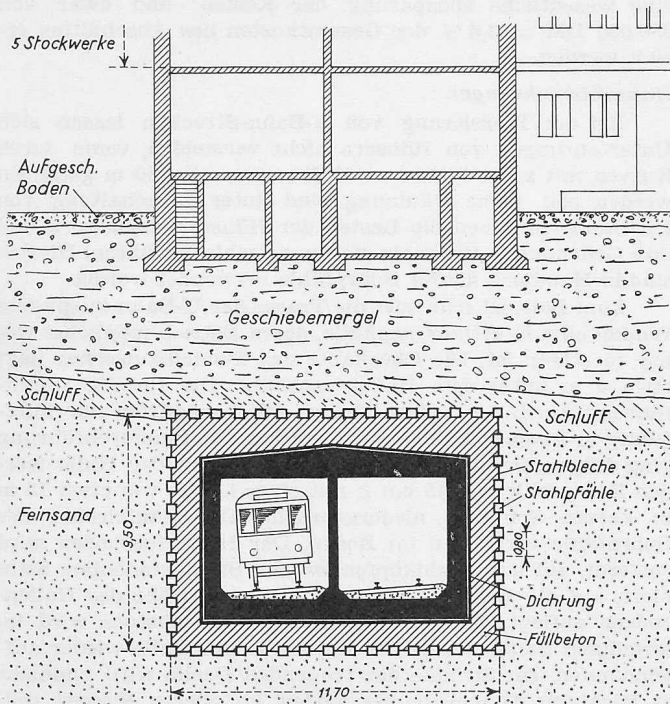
Tunnelquerschnitt im Schutz eines Stollens aus Stahlpfählen. Masstab 1:250
